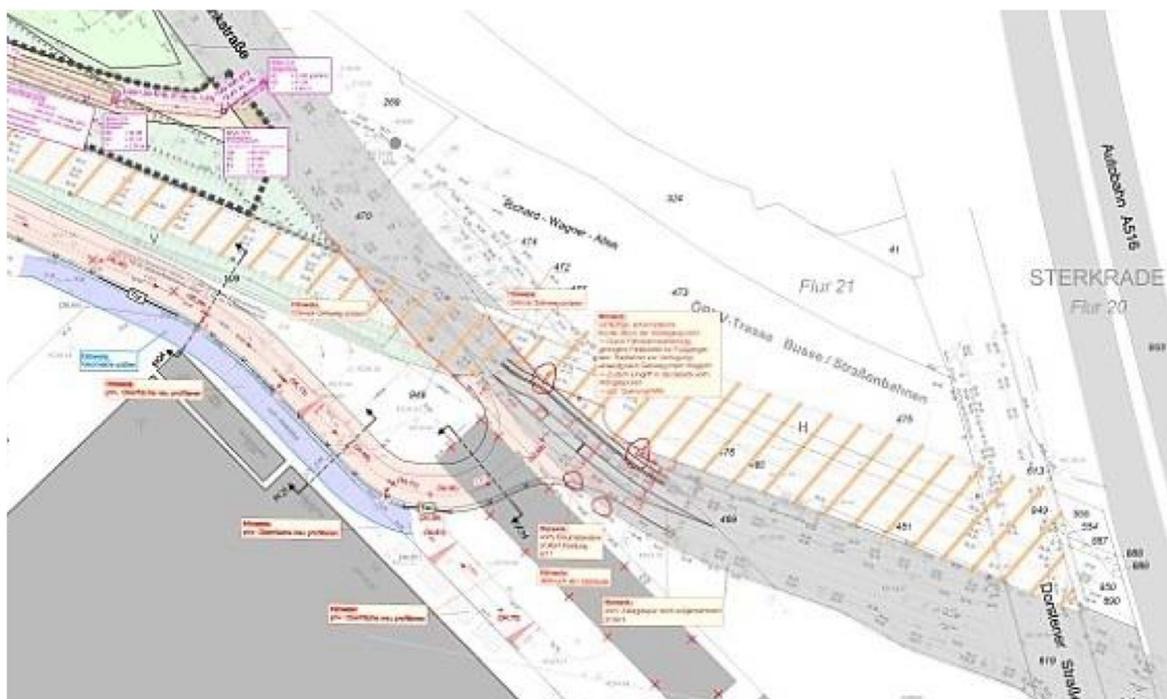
Konzept zur Gestaltung des Knotenpunktes Steinbrinkstraße / Zufahrt Gewerbe
